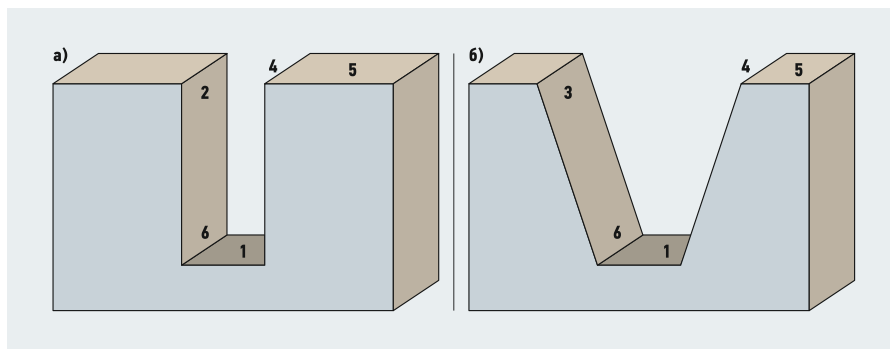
Траншеи для размещения ВПТ из ТПСС (а и б — с прямыми боковыми стенками и с откосами; 1 — дно; 2 — боковая стенка; 3 — боковой откос; 4 — бровка; 5 — берма; 6 — подошва)
